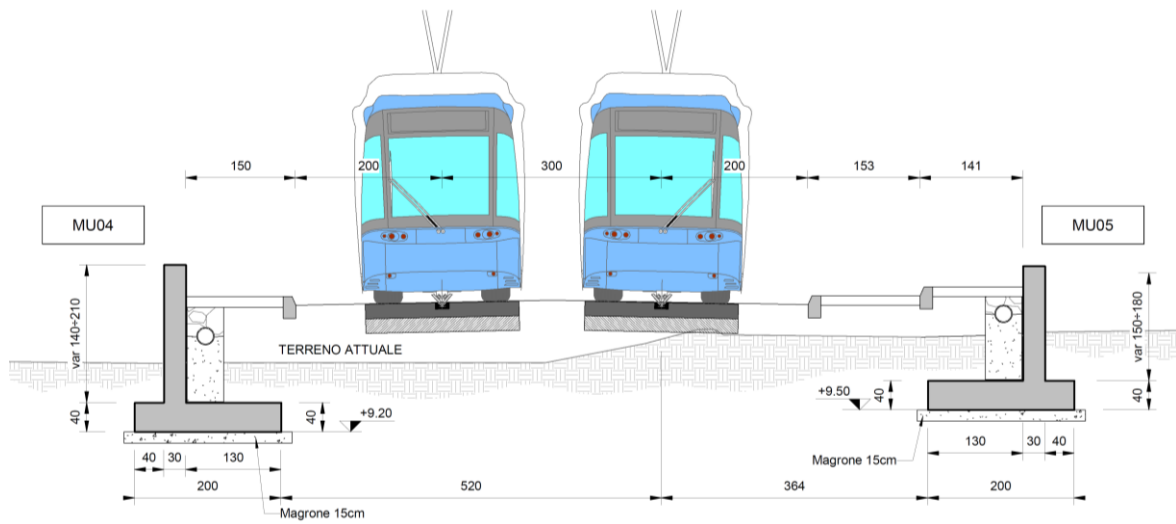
Sezione trasversale muri di sostegno MU04-05
